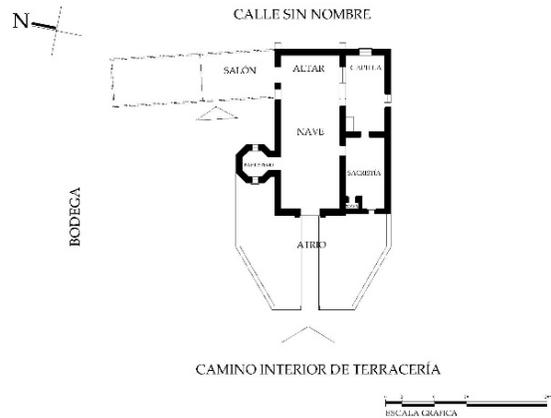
Ficha de descripción de elementos arquitectónicos y planta de la capilla San José de Tapia
